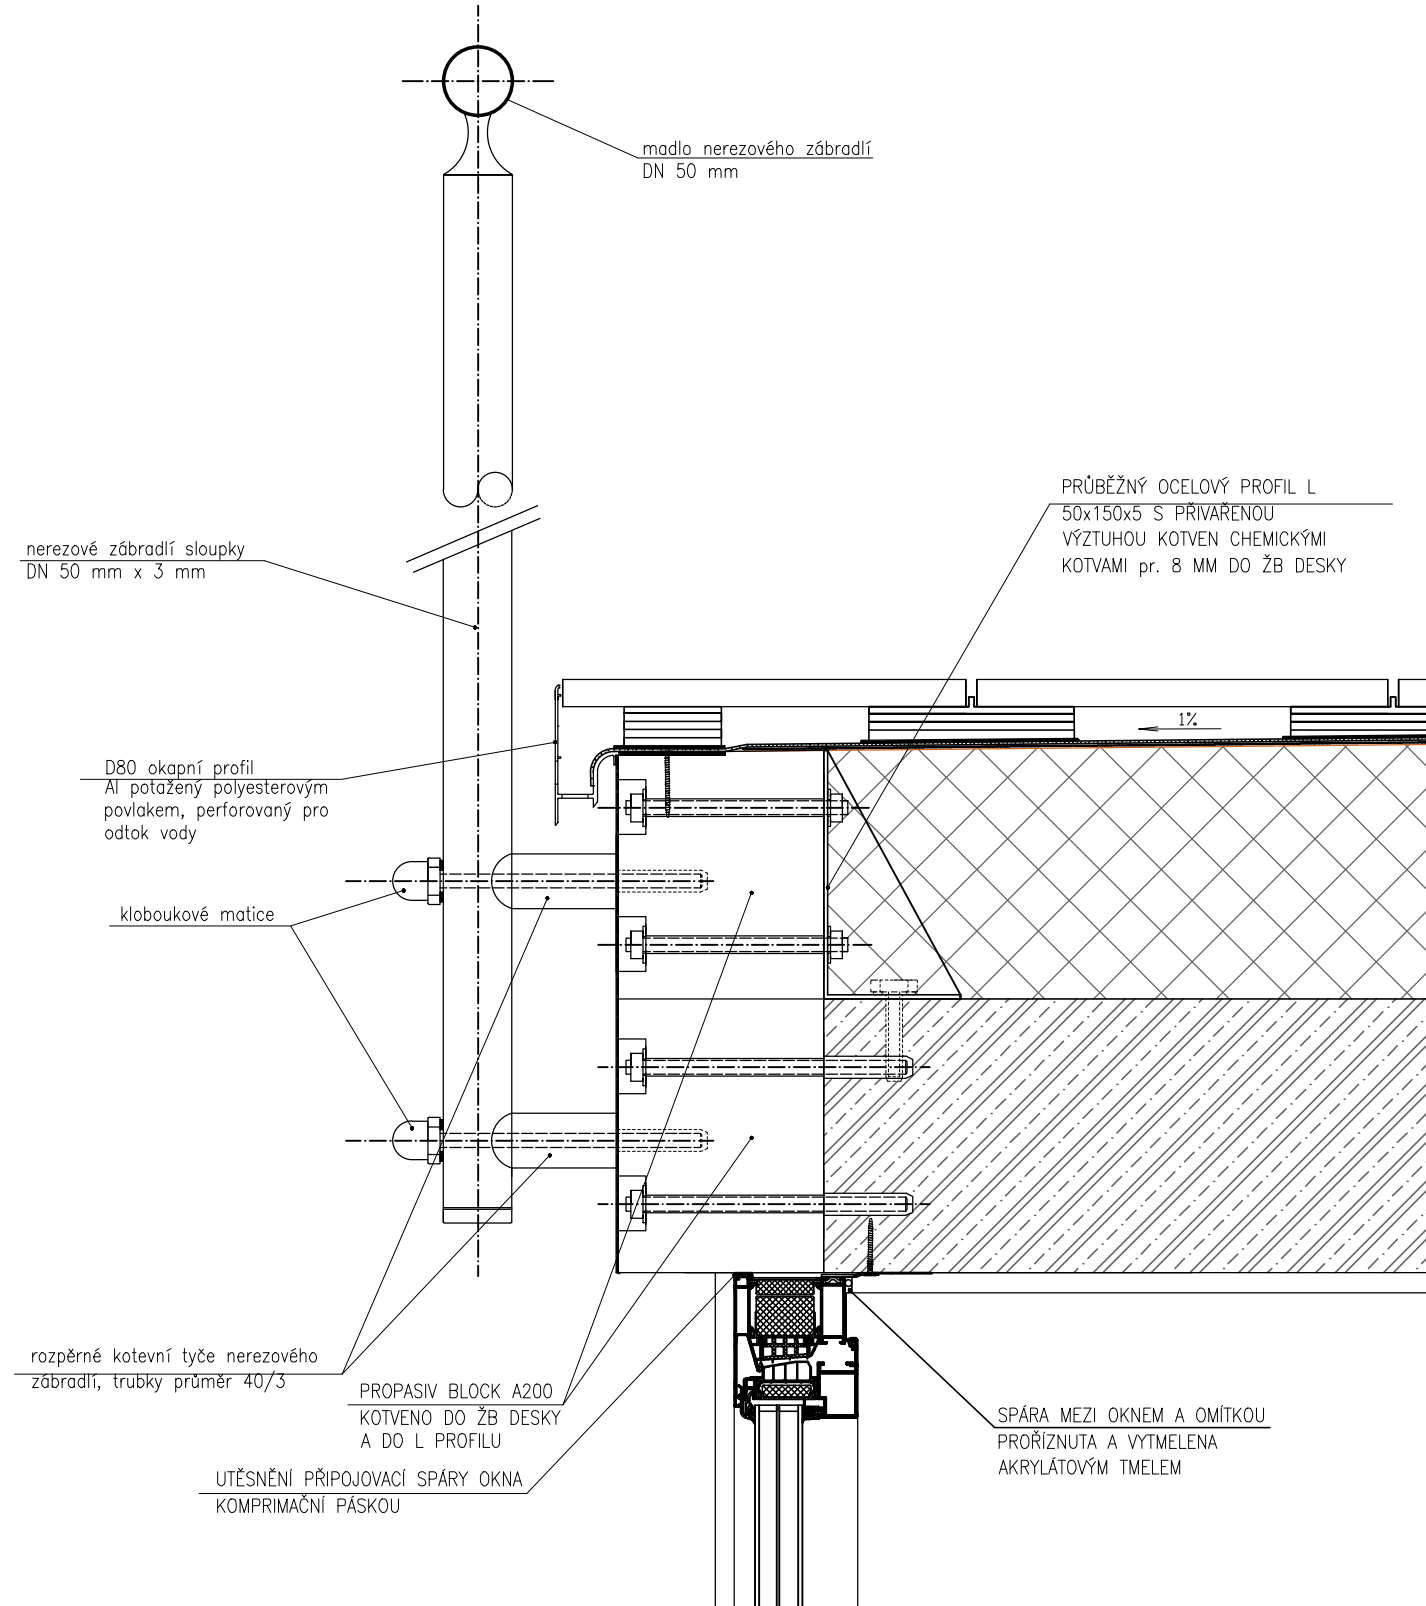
# DETAIL D: KOTVENÍ ZÁBRADLÍ LODŽIE M 1:5
